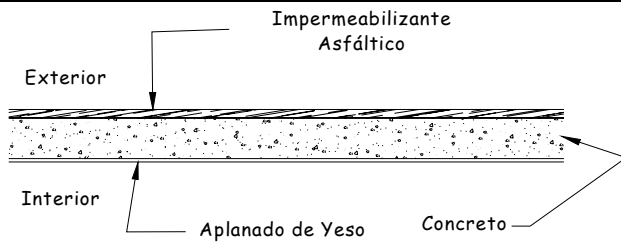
Detalle del techo, losa sólida de concreto sin aislamiento
